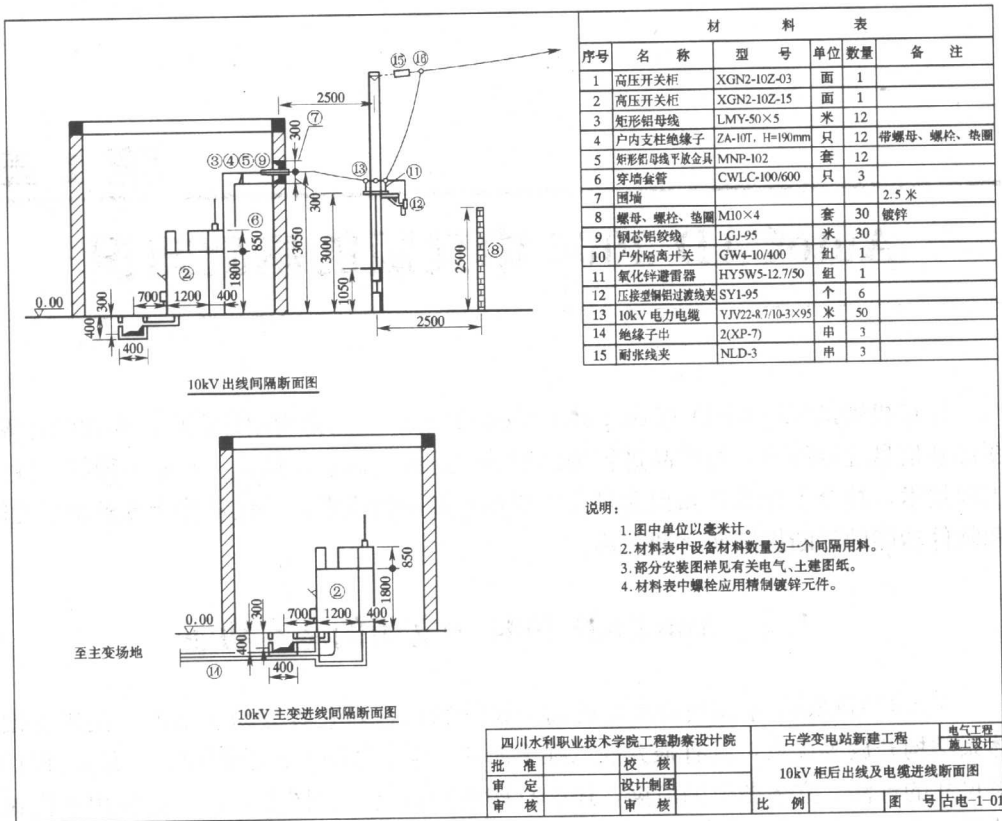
使用 AutoCAD 2004 绘制的二维平面图形
